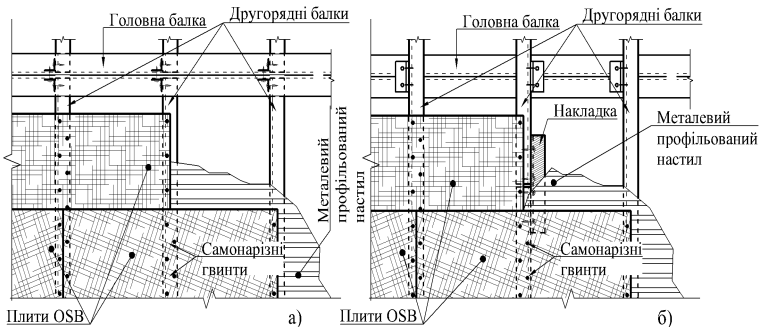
Фрагмент плану конструкції перекриття з ЛСТК:
